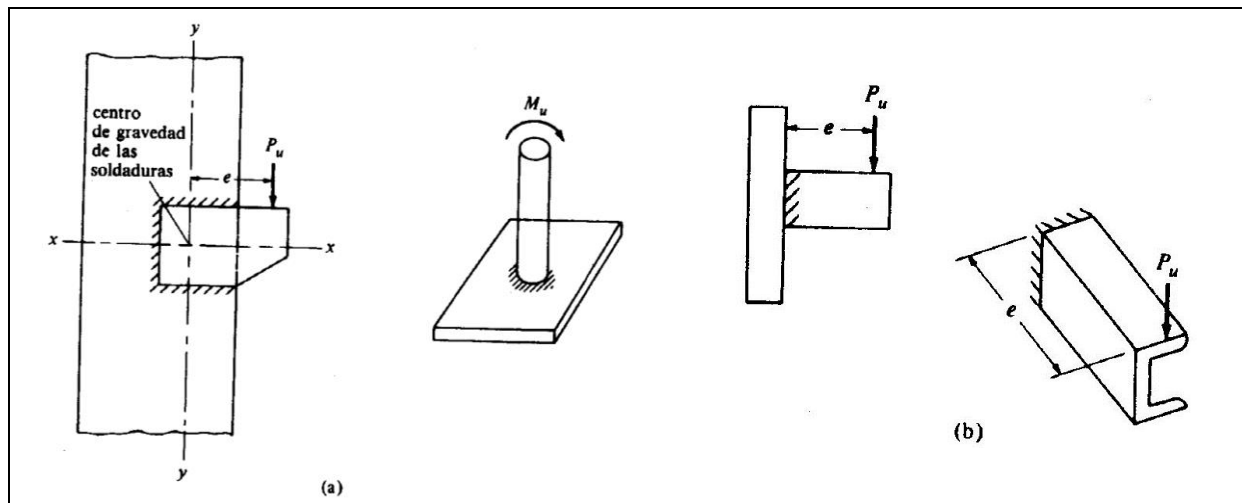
(a) Soldaduras sometidas a cortante y torsión. (b) Soldaduras sometidas a cortante y flexión
